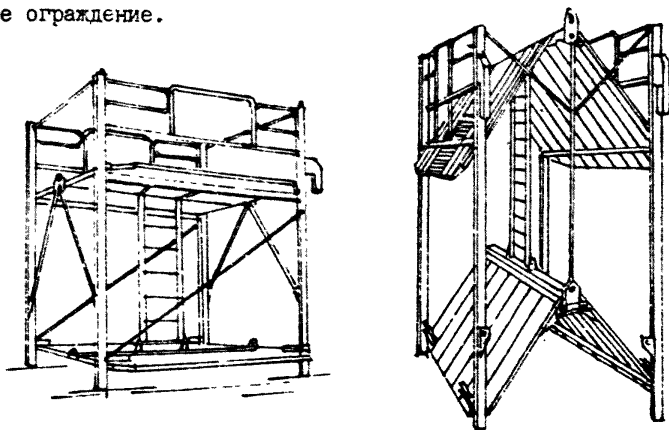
Внутренние складывающиеся подмости треста Элеватороргстрой для корпусов типа СКС.
